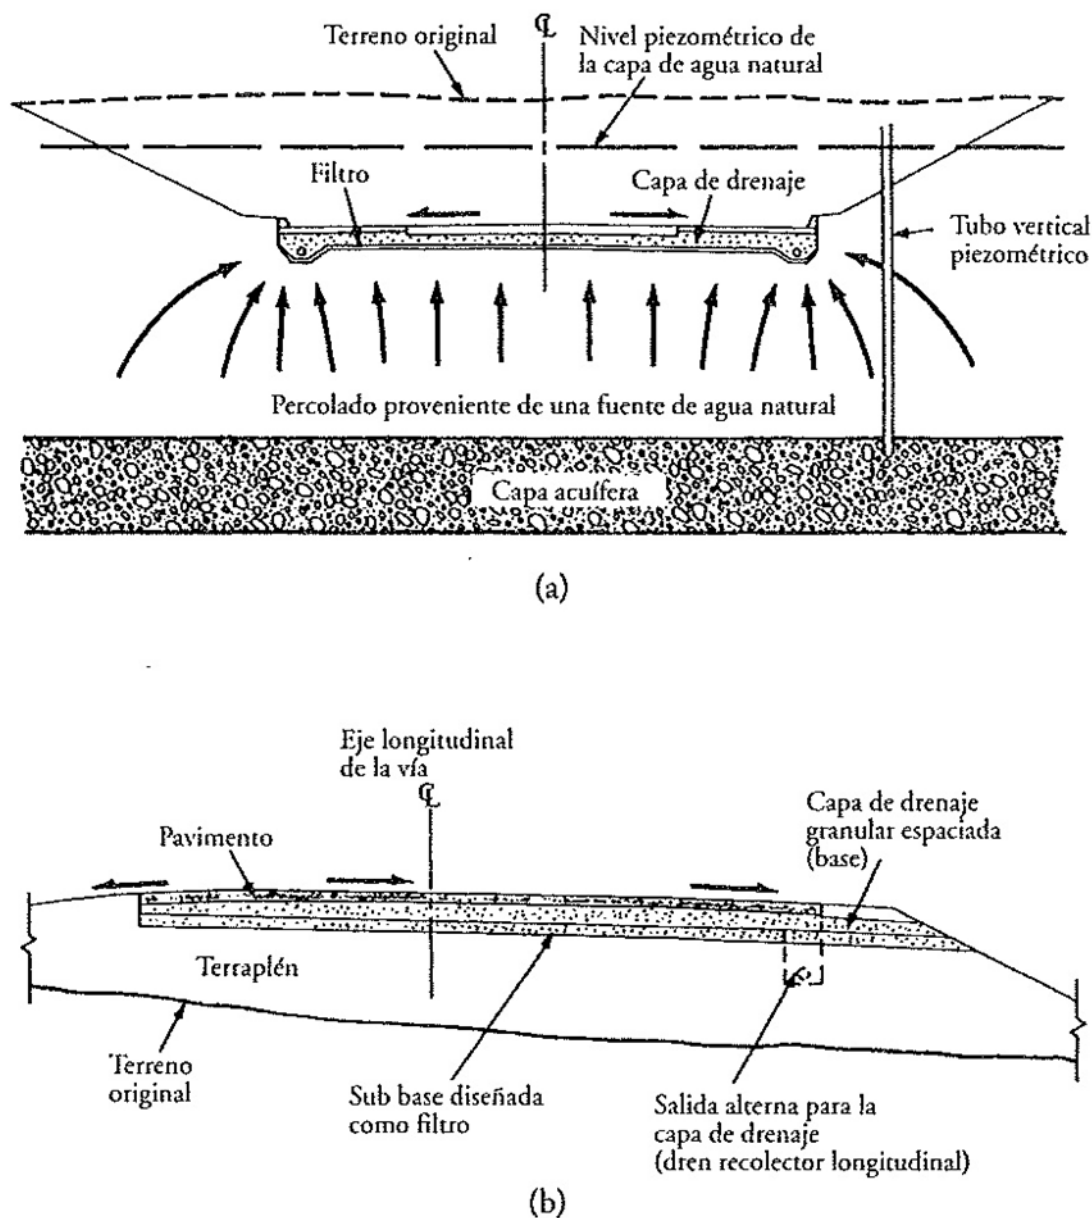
Aplicaciones de las capas de drenaje horizontales. (Garber & Hoel, 2007)
